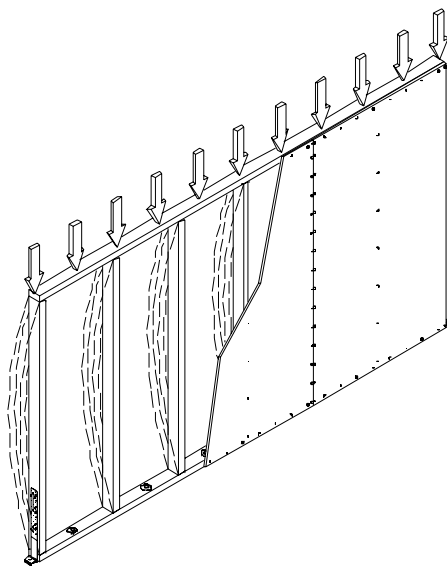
Parete Platform soggetta a carichi verticali. La resistenza è devoluta ai montanti verticali che si possono instabilizzare solo nel piano ortogonale alla parete, in quanto l'instabilizzazione nel piano della parete è impedita dai pannelli di rivestimento strutturale.
